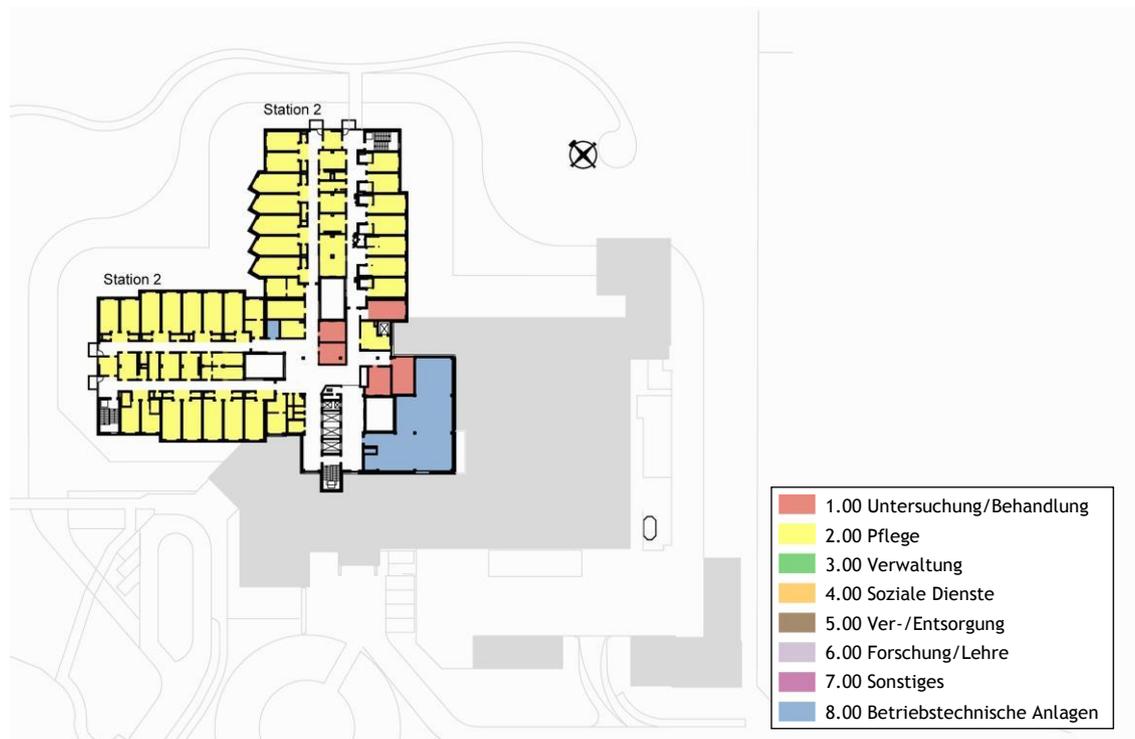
SOLL-Flächen nach DIN 13080 - 3.Obergeschoss
